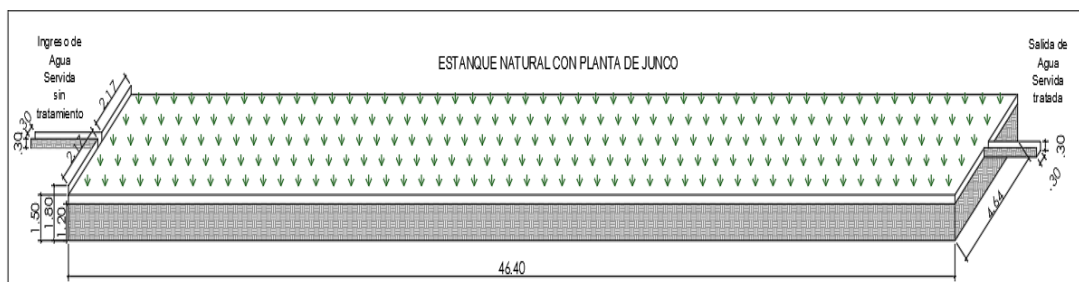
Diseño de estanque natural con plantas de junco según la teoría del pistón.
